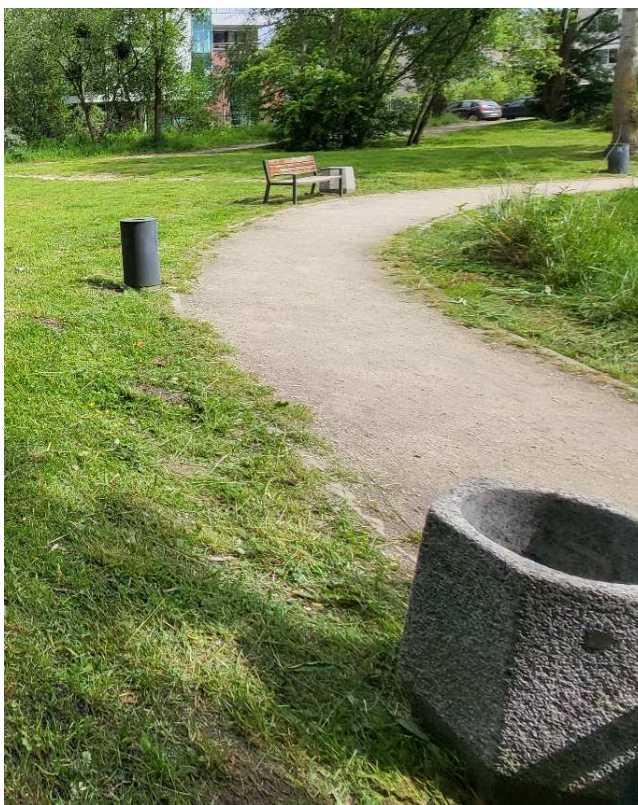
Przeдепт prowadzący w kierunku projektowanego placu zabaw
